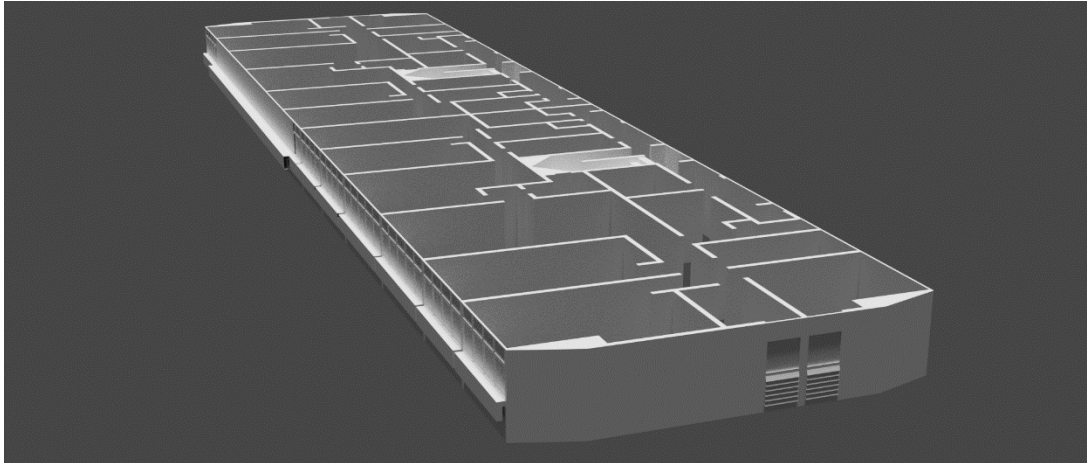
Modelagem inicial do pavimento do edifício. Renderização inicial de teste.
